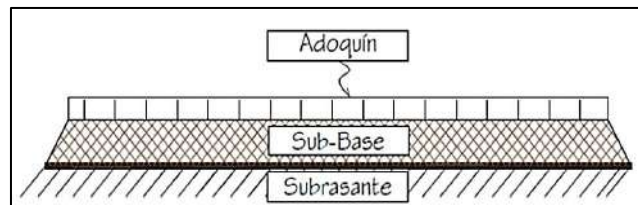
Sección transversal típica de pavimento articulado Armijos [42]
